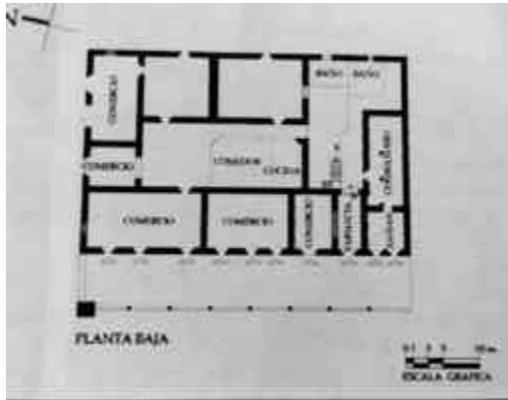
Planta baja de la vivienda ubicada en el portal Flores. Autor: Yoné González Méndez.
